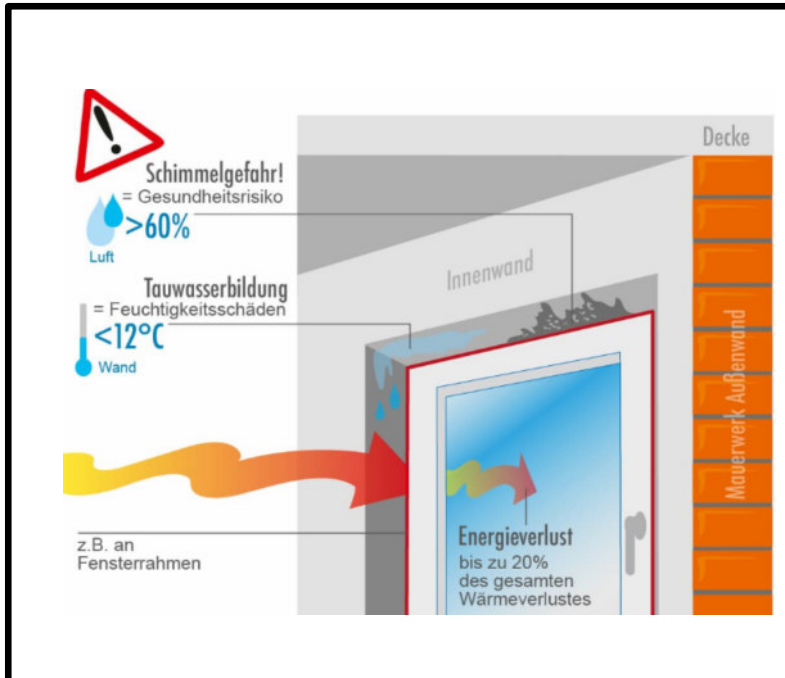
Fensterlaibung – außengedämmtes Mauerwerk
